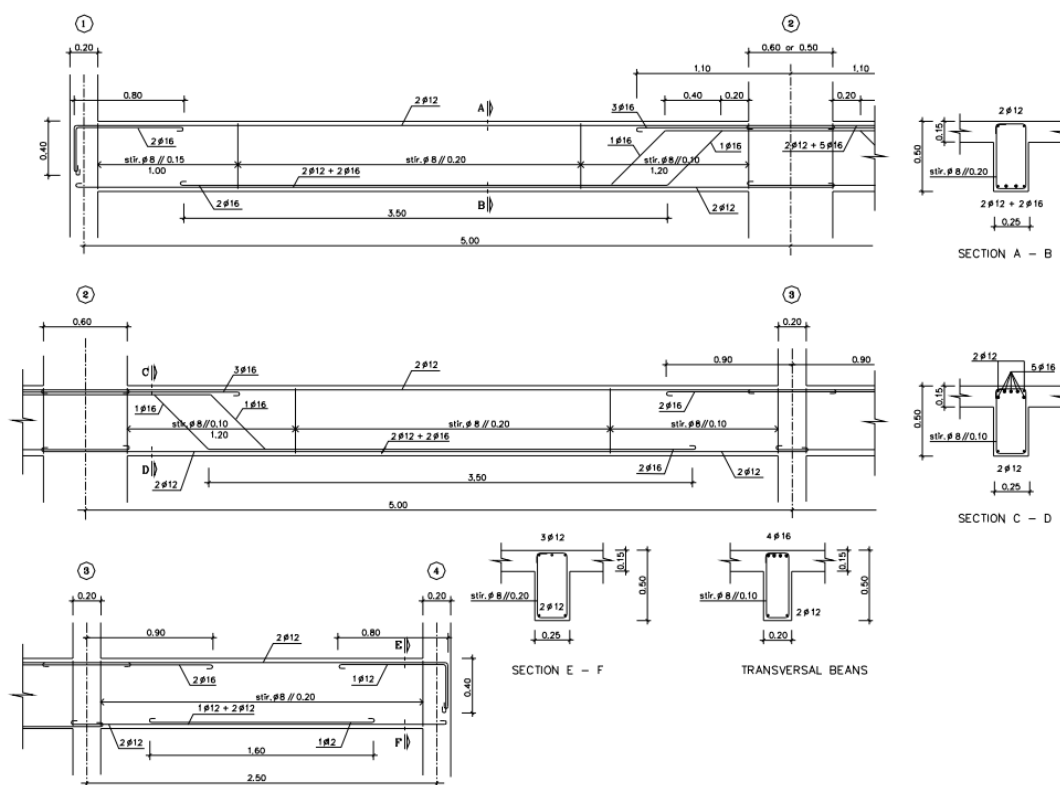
Geometria e pormenores de armadura das vigas (Carvalho et al., 1999)
